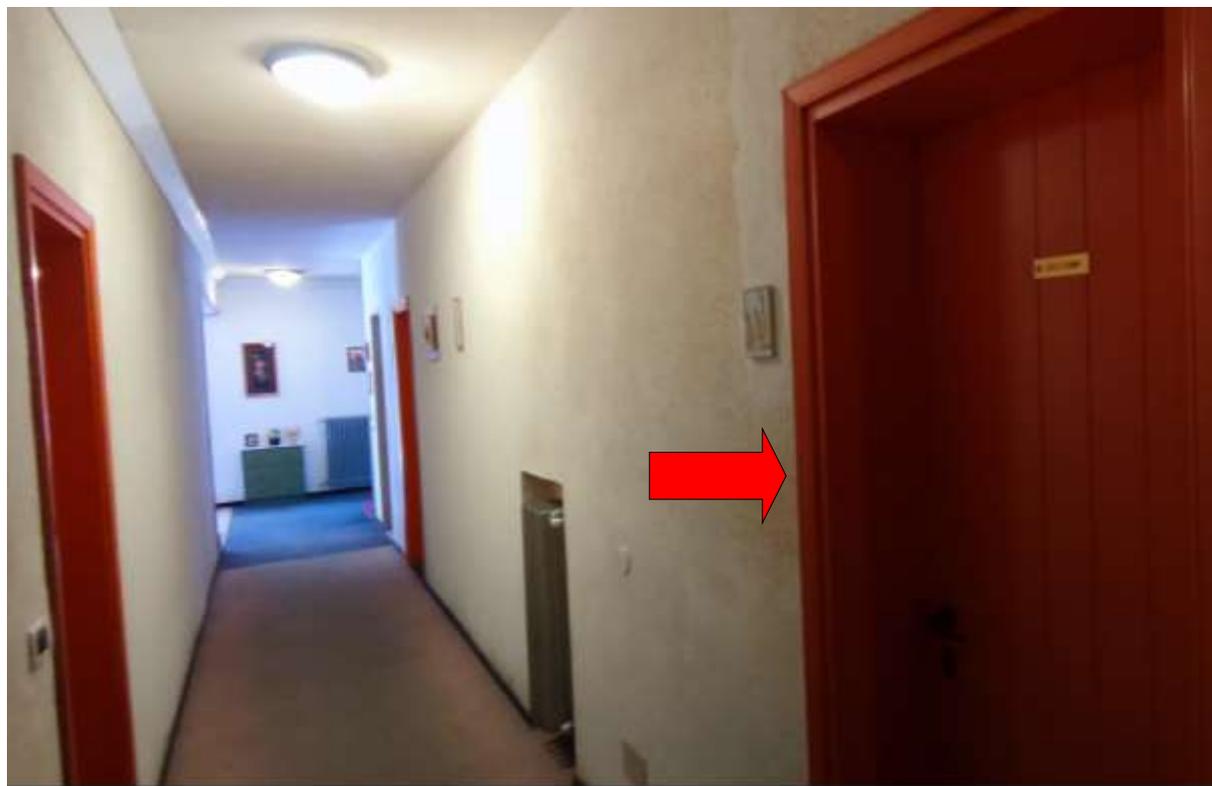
Corridoio comune di accesso all'appartamento al piano terra
